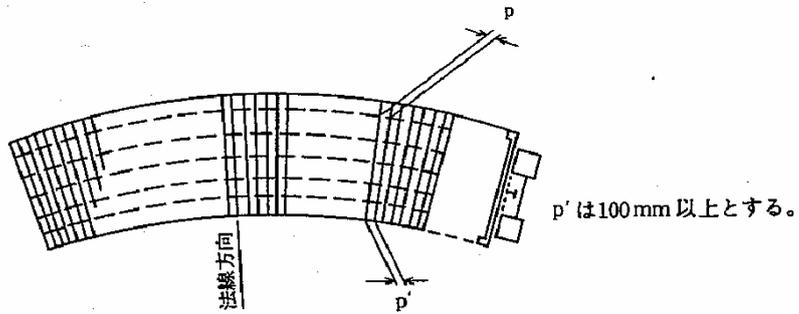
主鉄筋の配筋方向 (支承線が法線方向と一致する曲線橋の場合)
